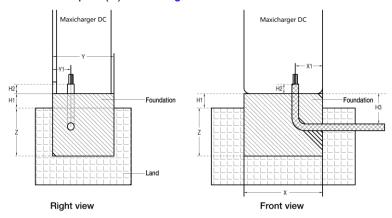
Coulage du béton et pose du conduit Tableau 5-4 Spécifications de la fondation
